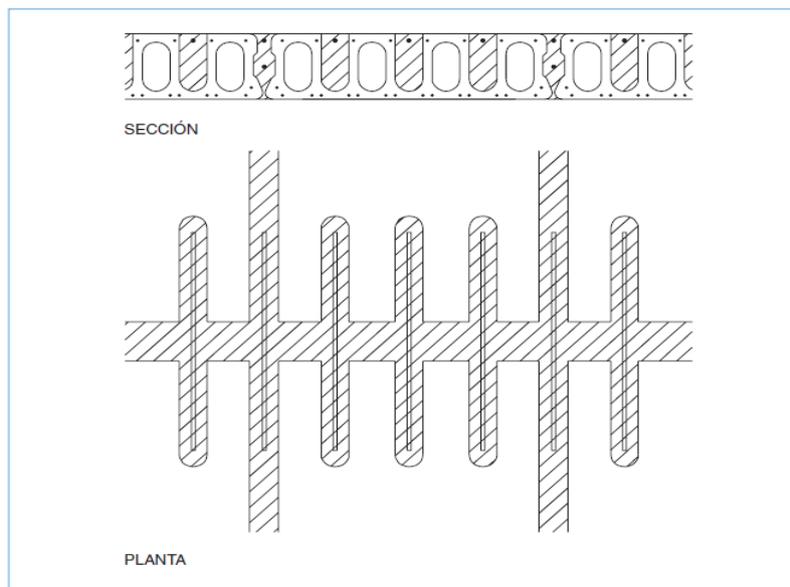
Planta y sección de la armadura superior de unión en losas alveolares pretensadas. Tomado de Figura 59.2.4.a. de EHE-08.
